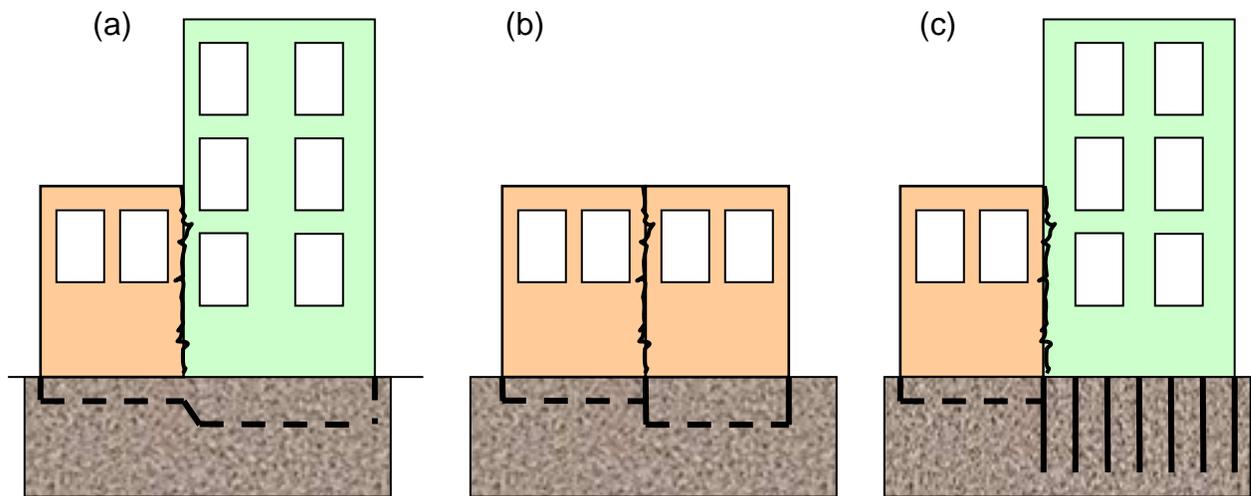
Exceções de tipo de fissura em edificações devido a movimentações diferenciais (SILVA, 1993).
